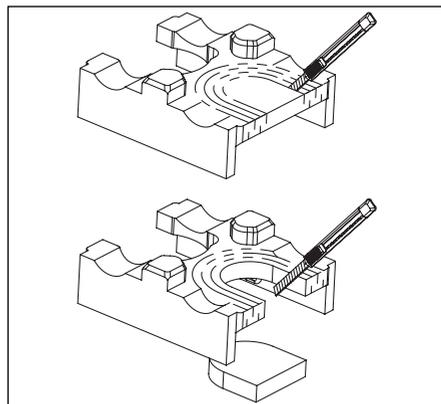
Einlegeblock mit Ausschnitt für Wärmemengenzähler
